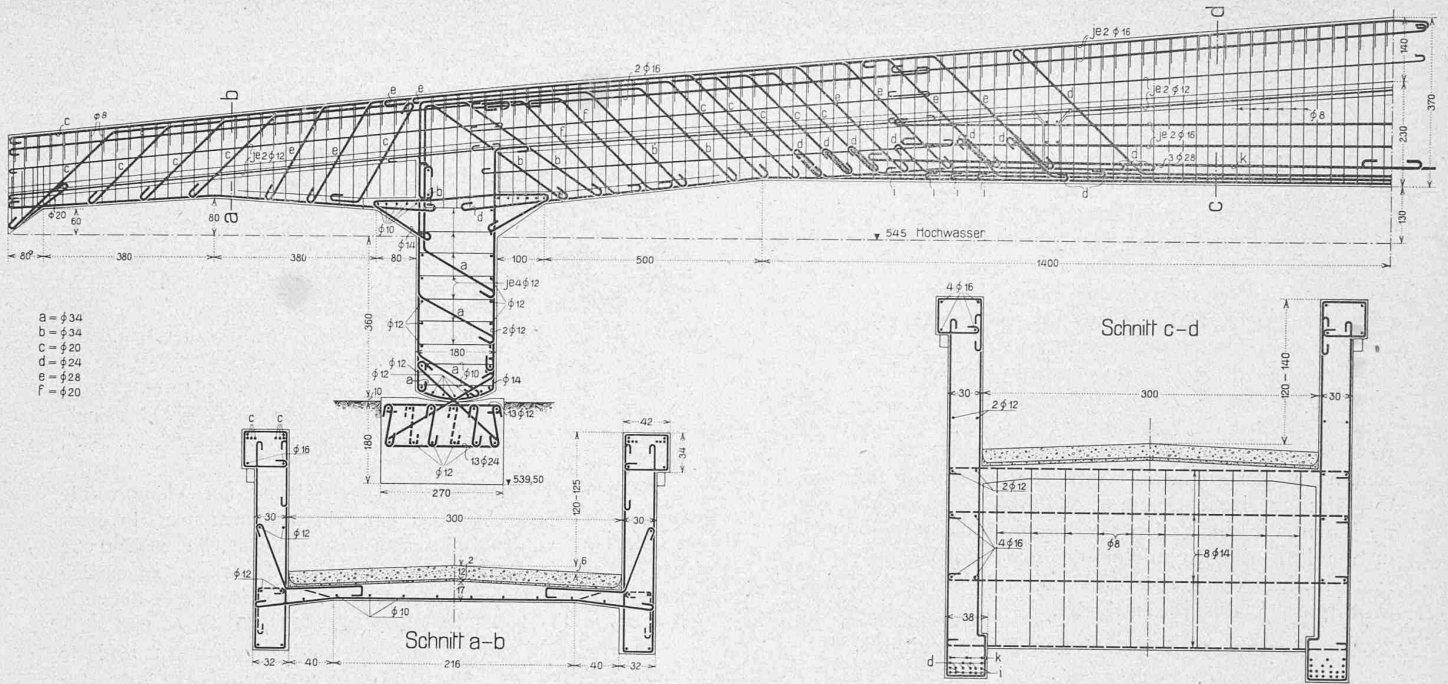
Armierungsplan der Waldeckbrücke bei Burgdorf. — Ansicht etwa 1 : 150, Schnitte 1 : 60.
